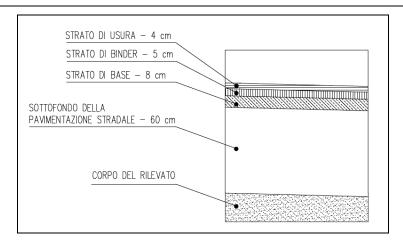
PARTICOLARE PACCHETTO STRADALE
